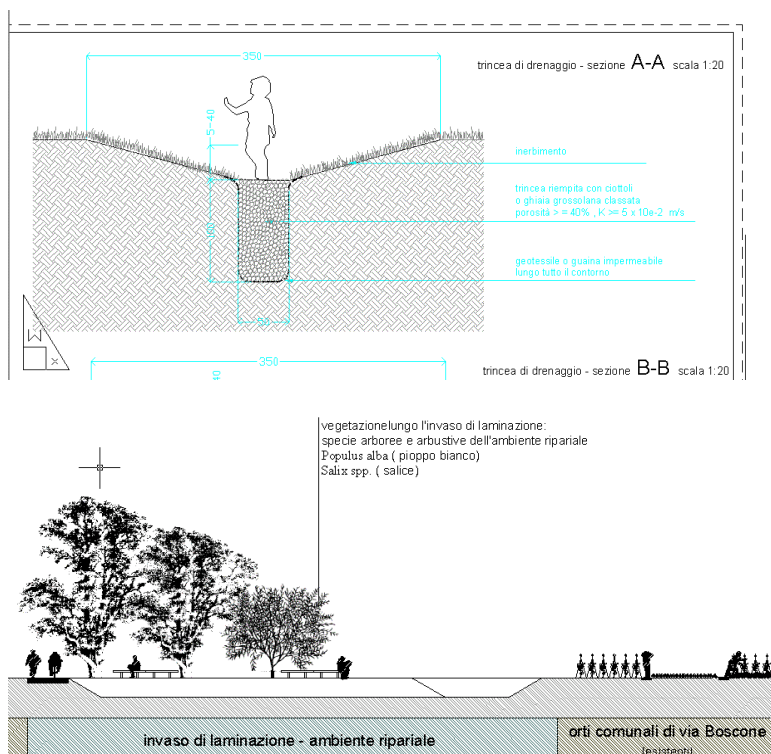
(sopra) sezione schematica delle canalette-trincee drenanti; (sotto) vista di ambientazione dei volumi di laminazione, che configurano una zona ripariale. Cortesia arch. E.Dall'Ara
